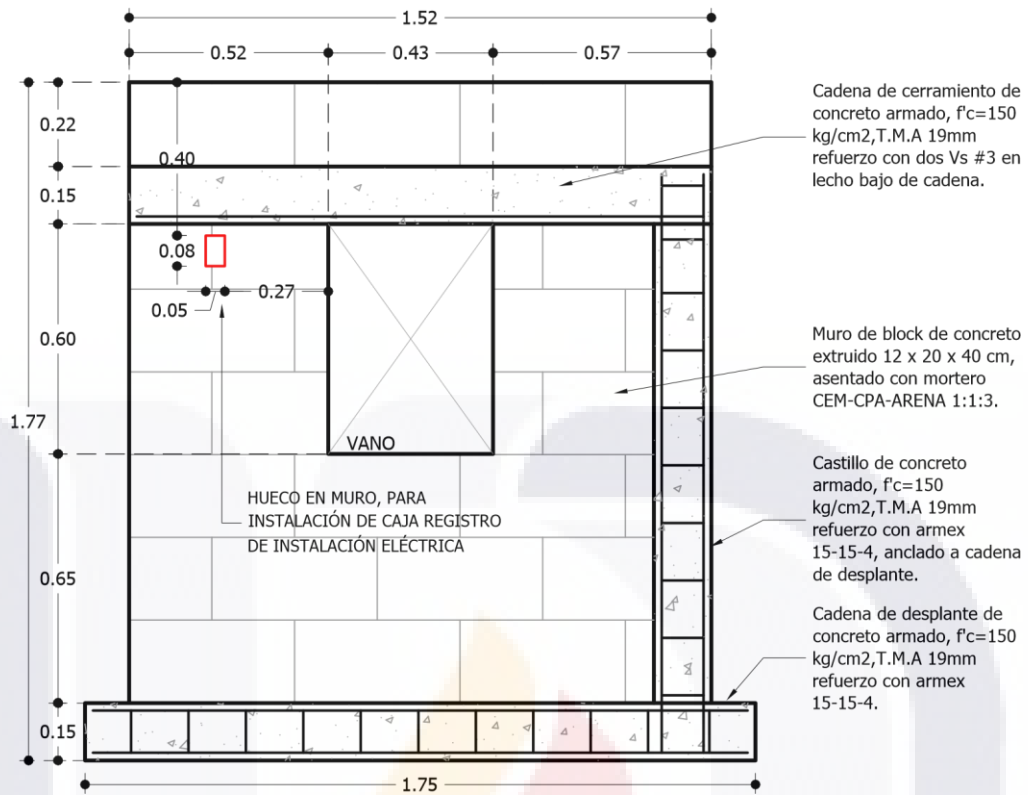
Detalle constructivo de diseño de MBC 1 Cara A
